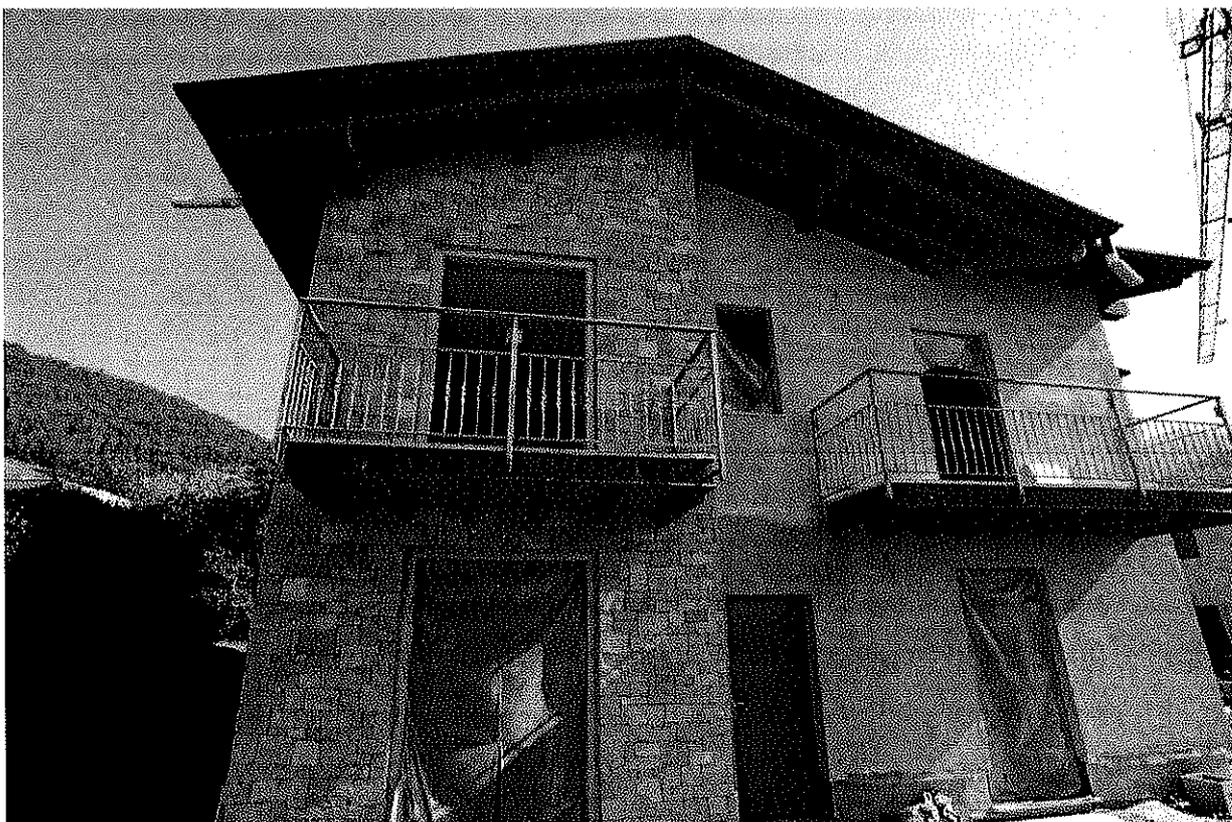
2 - Due immagini esterne del complesso edilizio in fase di cantiere visto da via Bergamo.
